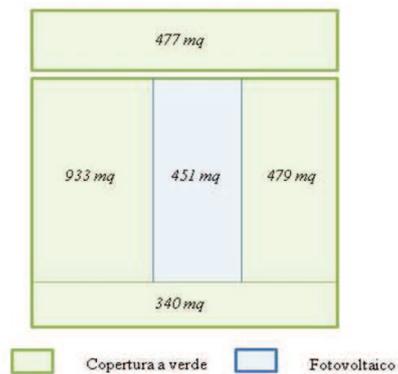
pianta copertura del Nuovo Molo [$\approx 2.500 \text{ m}^2$]
